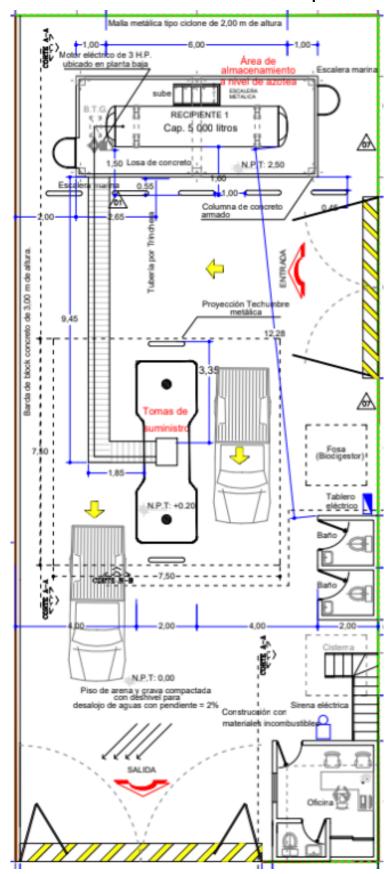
Plano de la planta general de la Estación de Gas L.P. para carburación
